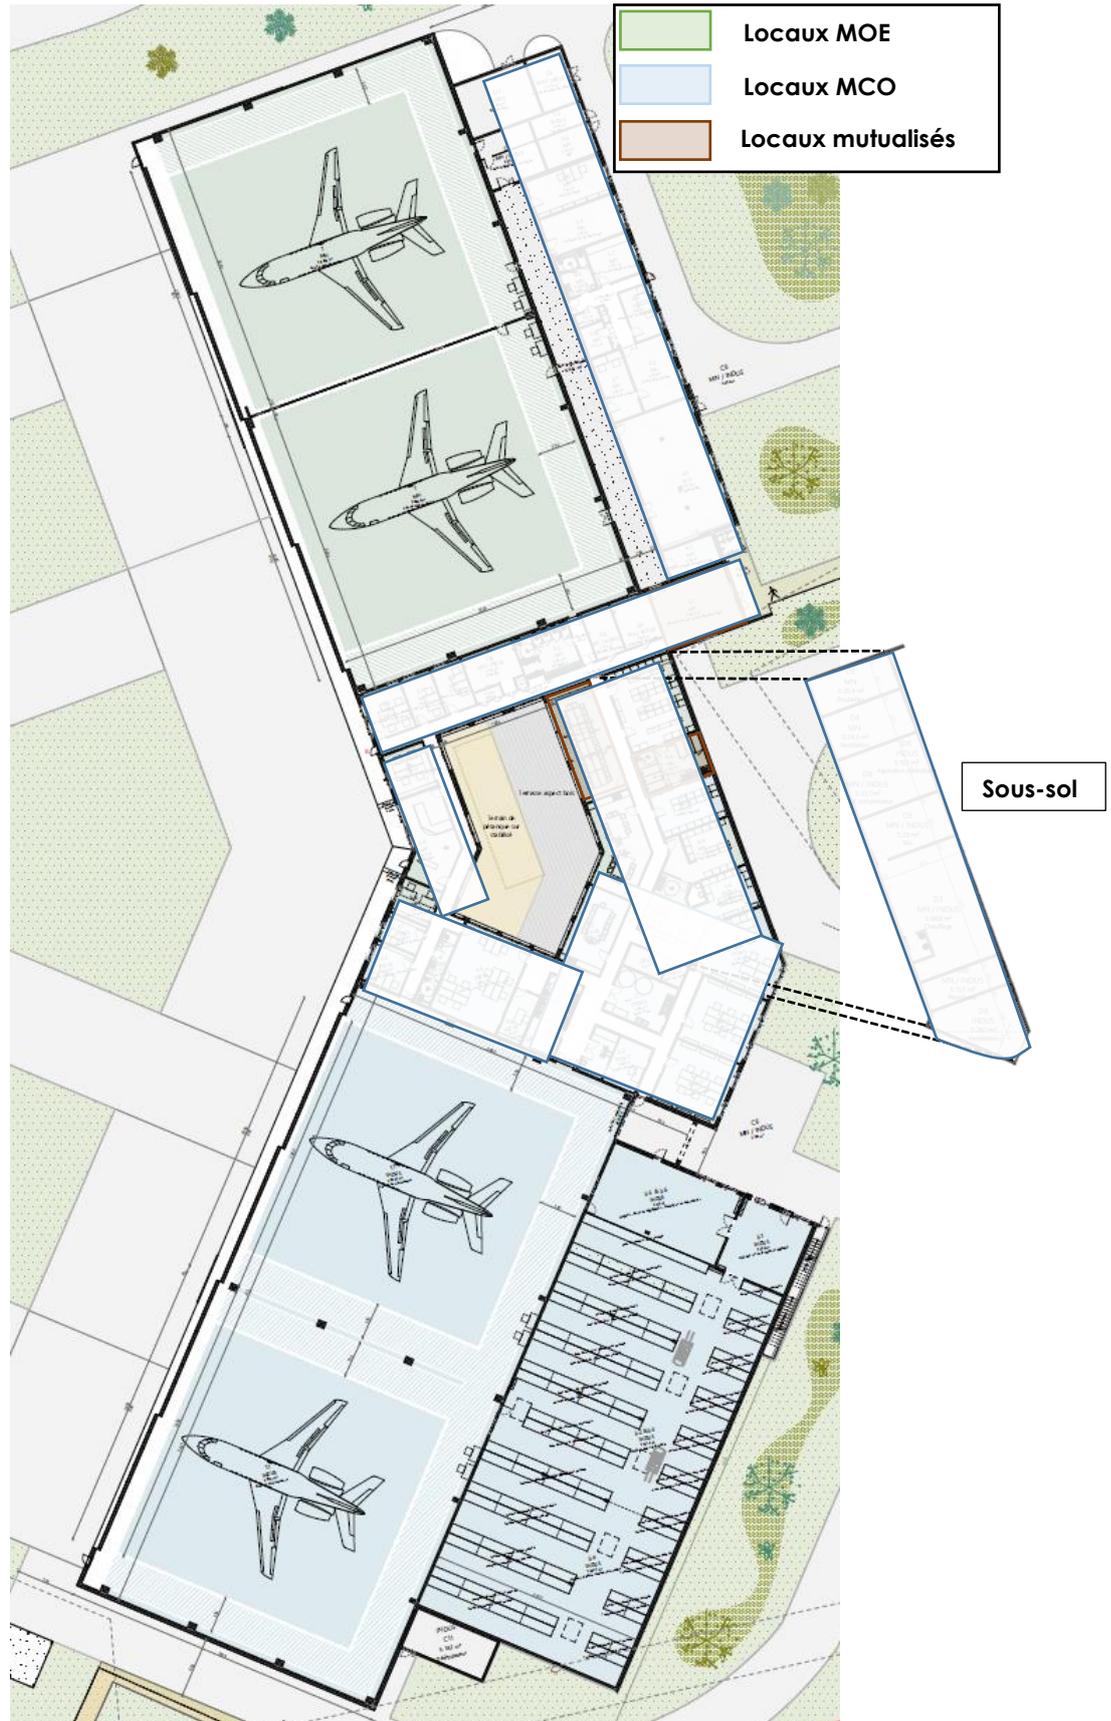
Plan masse d'implantation des locaux et bâtiment projetés
